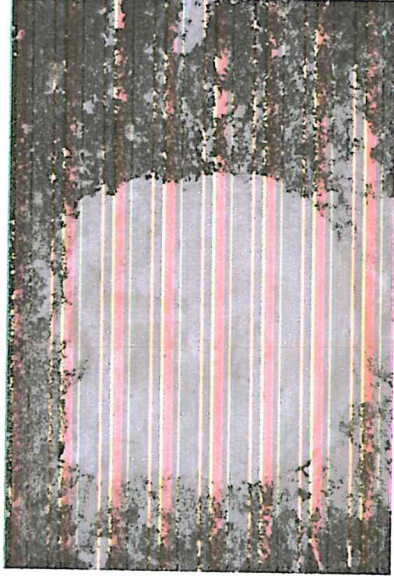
Prueba aplicada en el Edificio 161, tal como se puede apreciar en la foto 7
